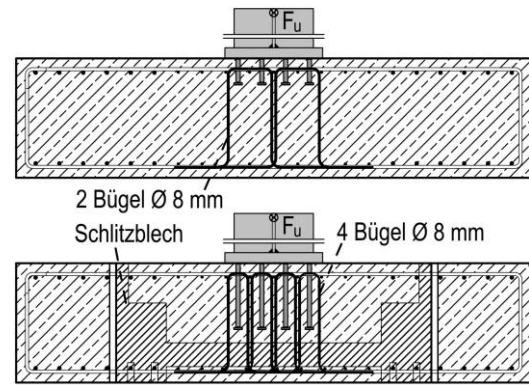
Lage der Rückhängebewehrung mit geringem Bewehrungsgrad (Versuch B3-Q, oben) und hohem Bewehrungsgrad in gerissenem Beton (Versuch R3-2Q(1), unten)
